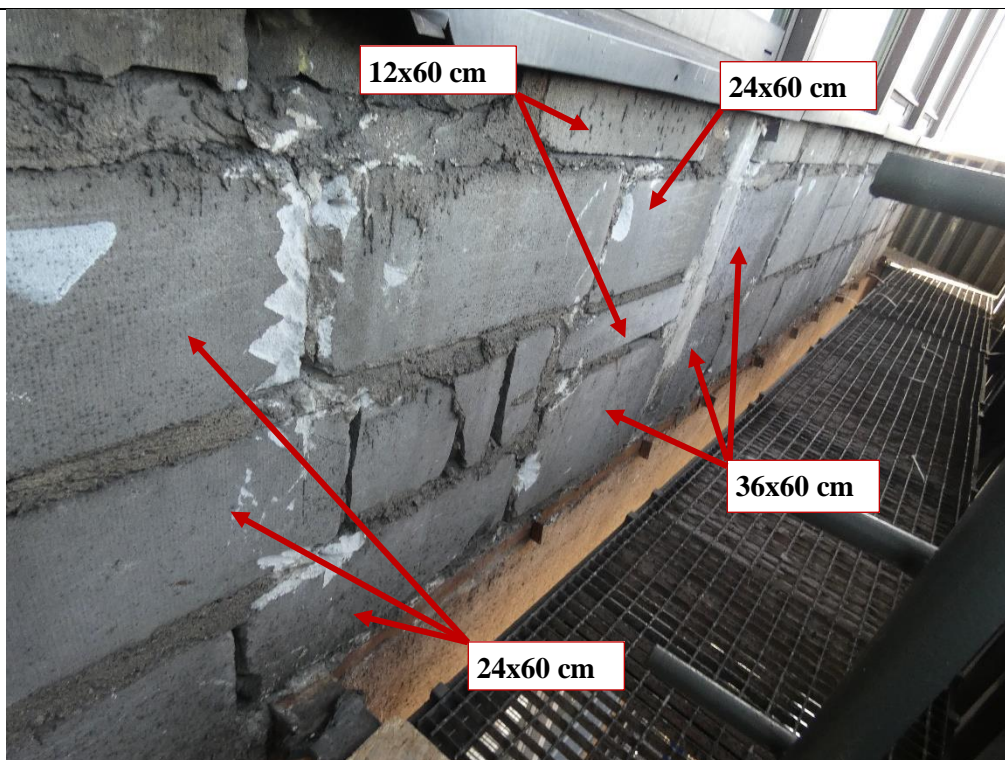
Przykładowe ubytki zaprawy w spoinach pionowych
